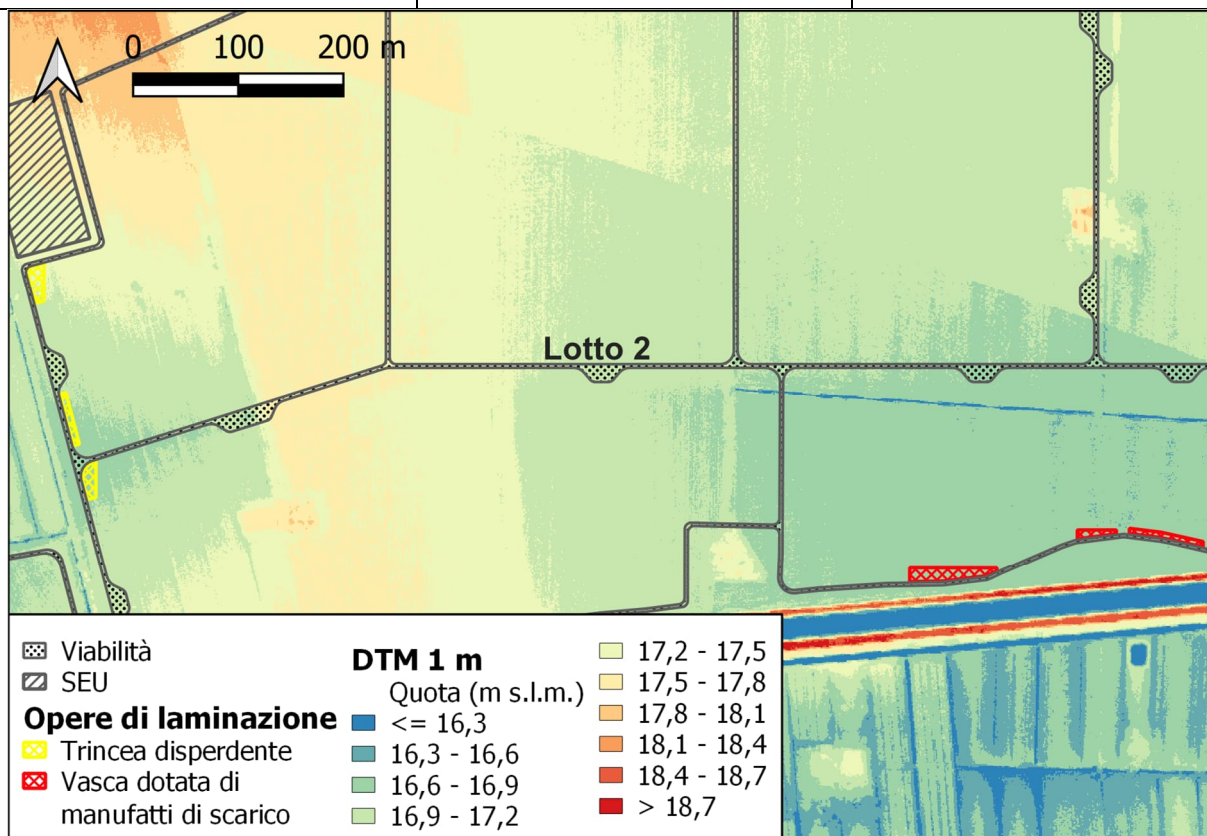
Posizionamento planimetrico delle opere di laminazione nel lotto 2.
